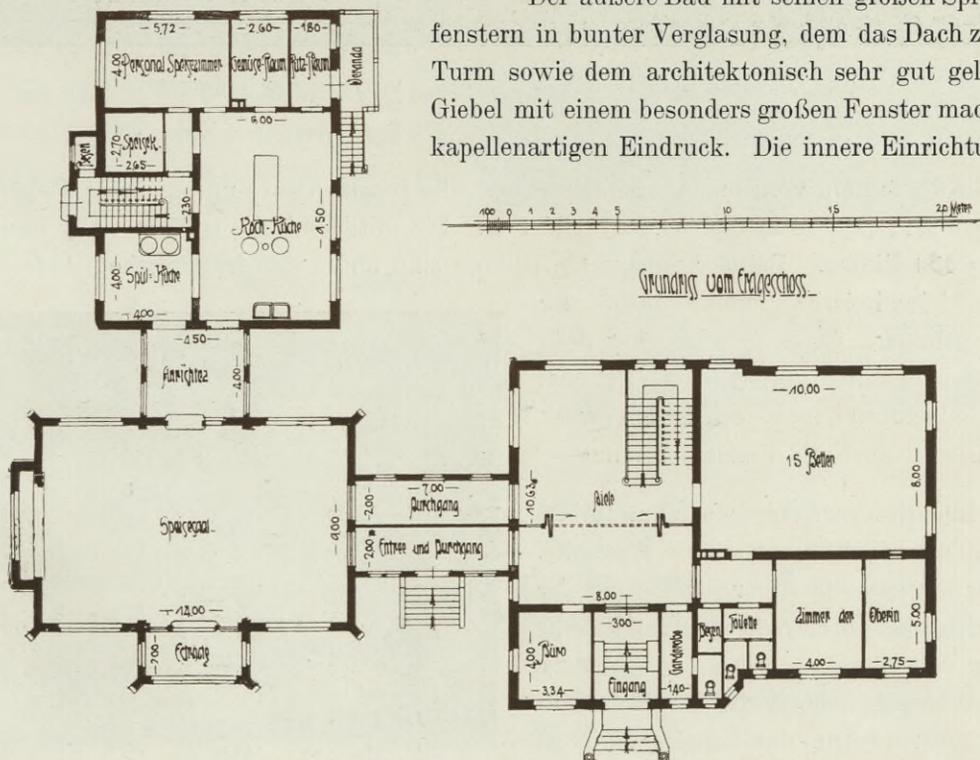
Ländliche Kolonie. Neues Hauptgebäude, Grundriß des Erdgeschosses.
